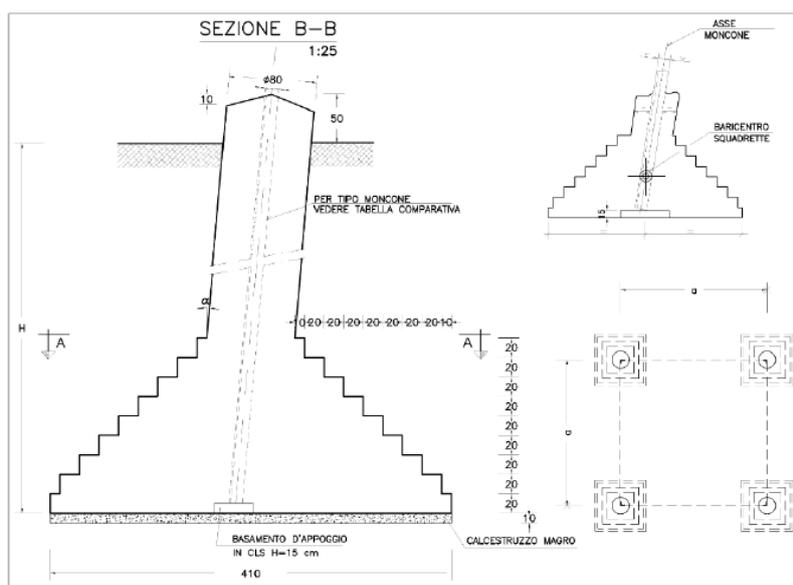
Schema tipo di fondazione superficiale per sostegni a traliccio
